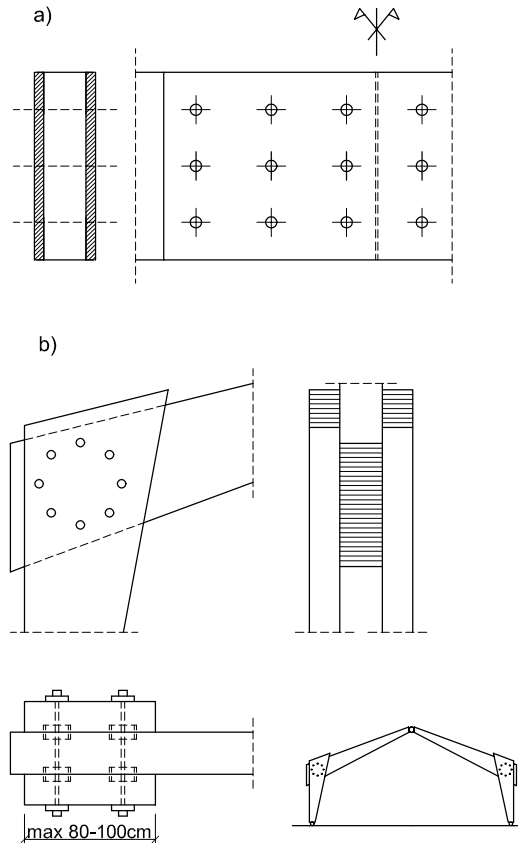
Ejemplos de detalles constructivos de protección de elementos estructurales.
